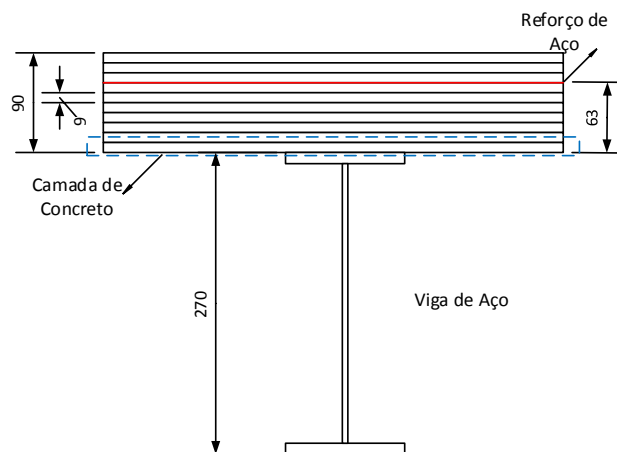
Esquema Camadas Laje de Concreto. Dimensões [mm]
